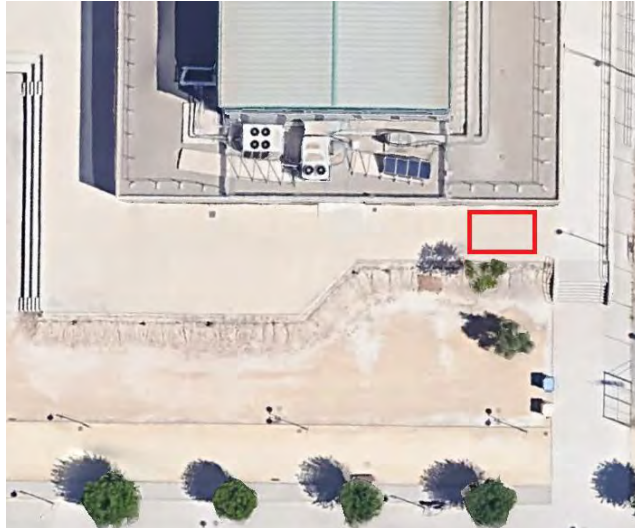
Situación de la zona de pretratamiento a excavar. Fuente: Google Maps.
